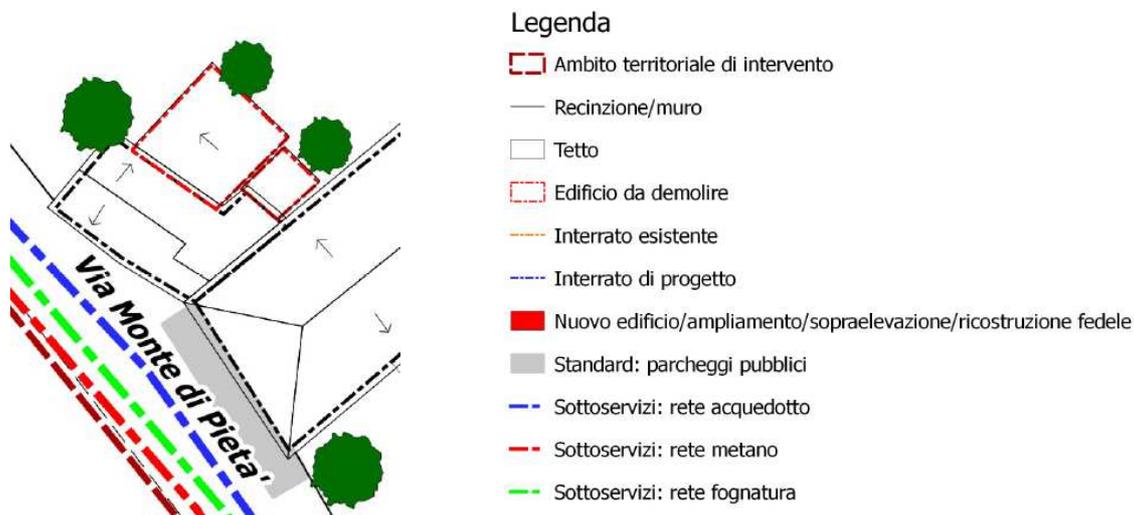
Estratto tav. 02 del PdR (progetto: pianta tetti e reti tecnologiche).
